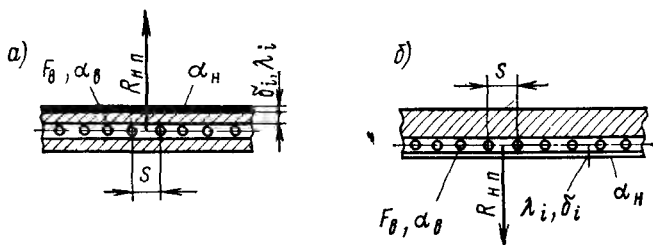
Расположение бетонной панели в конструкции многослойного ограждения
